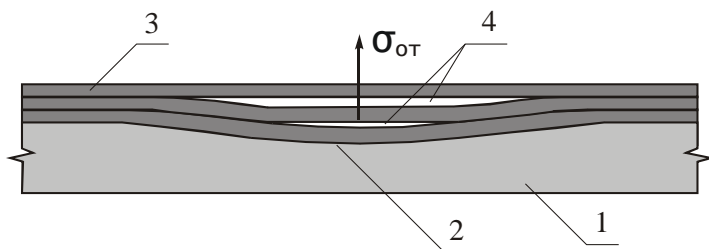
Сечение многослойной кровли на вогнутом участке основания:
